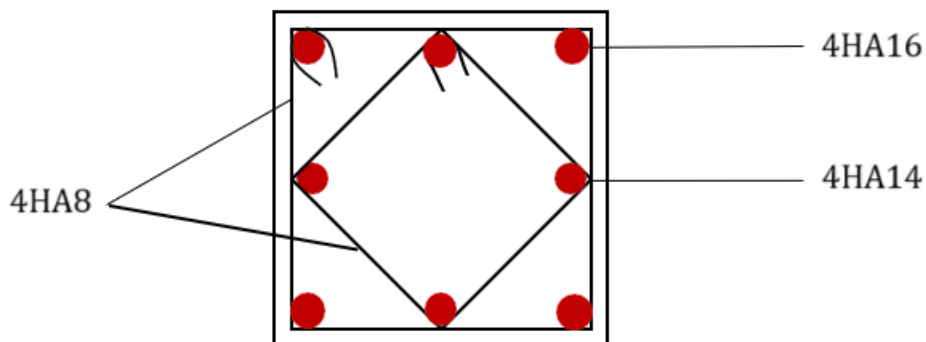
Schéma de ferrailage des poteaux (40×40) ; (35×35).
